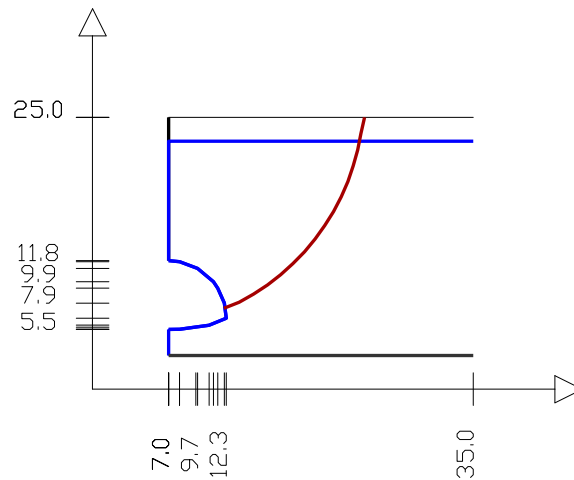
Vista frontal da metade direita do corte vertical do túnel pouco profundo através de um plano segundo o seu eixo longitudinal
